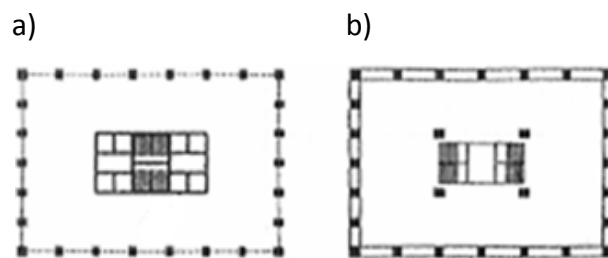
Grundrisse von a) Tragstrukturen mit innenliegendem Kern und b) außenliegendem „Tube“ (KOLBITSCH, 2008)
